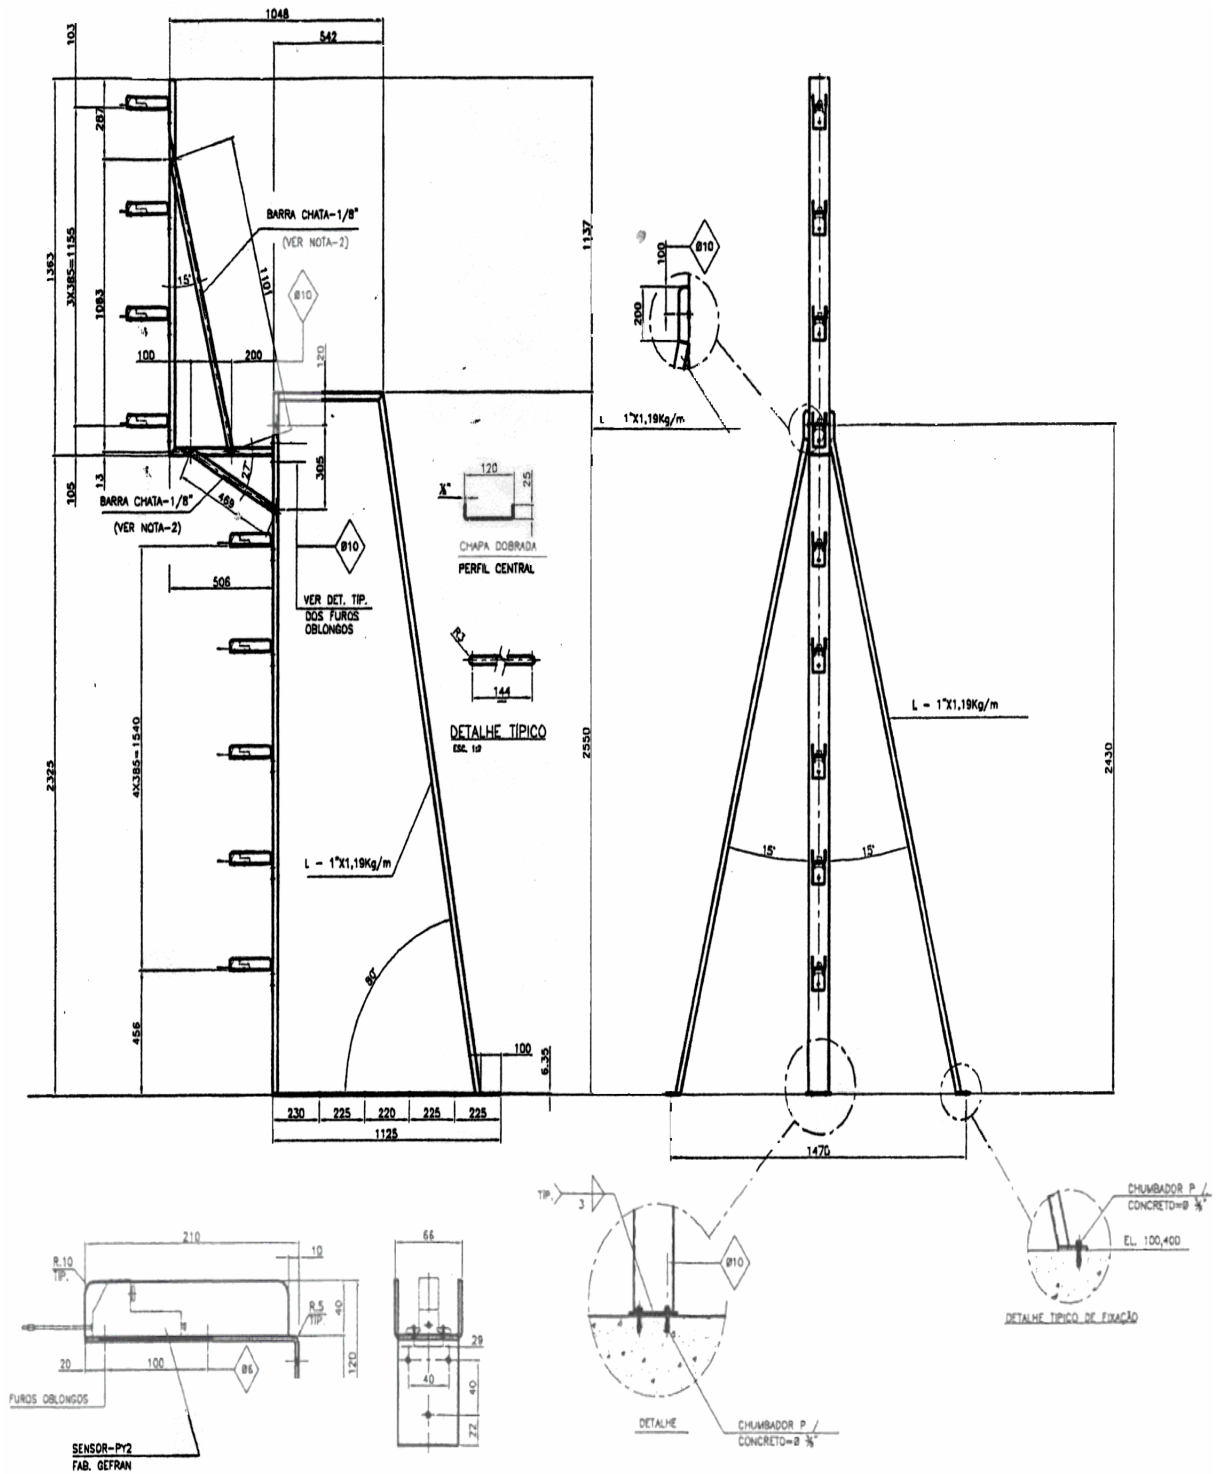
Projeto do suporte metálico dos sensores utilizado na medição de deslocamentos da linha do pilar.
